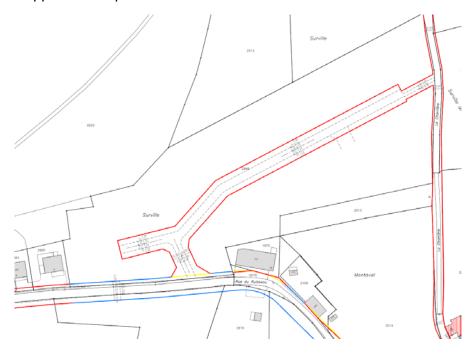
Extrait du plan d'alignement communal du secteur Surville, sanctionné par le Conseil d'Etat le 30 septembre 2013.
